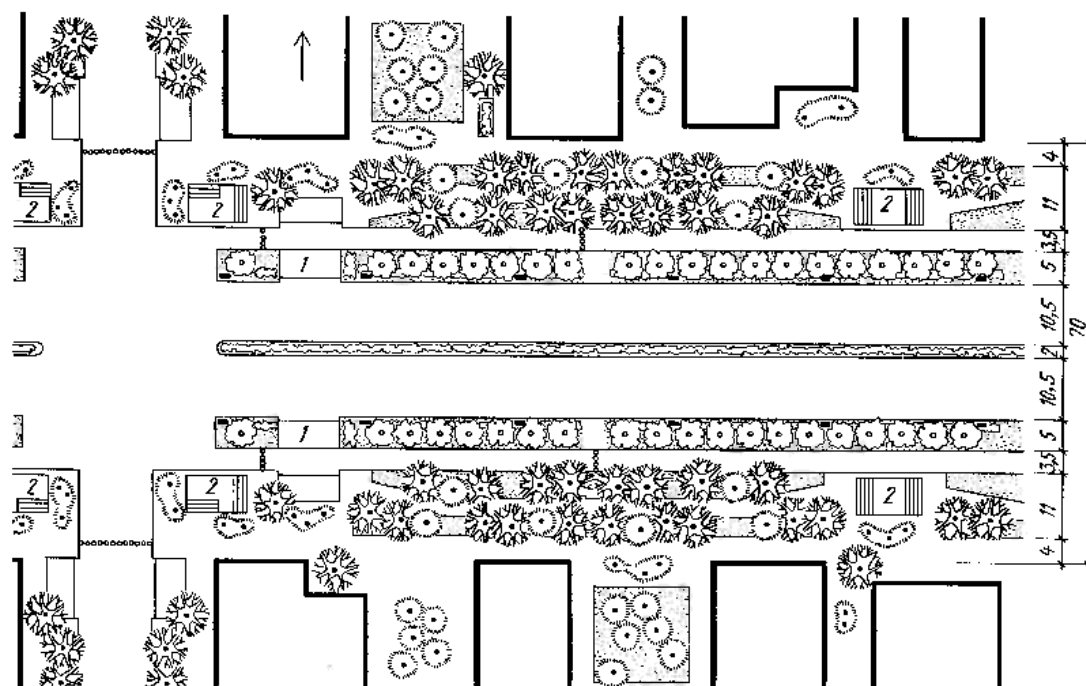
Фрагмент плана улицы с шумозащитными насаждениями:
